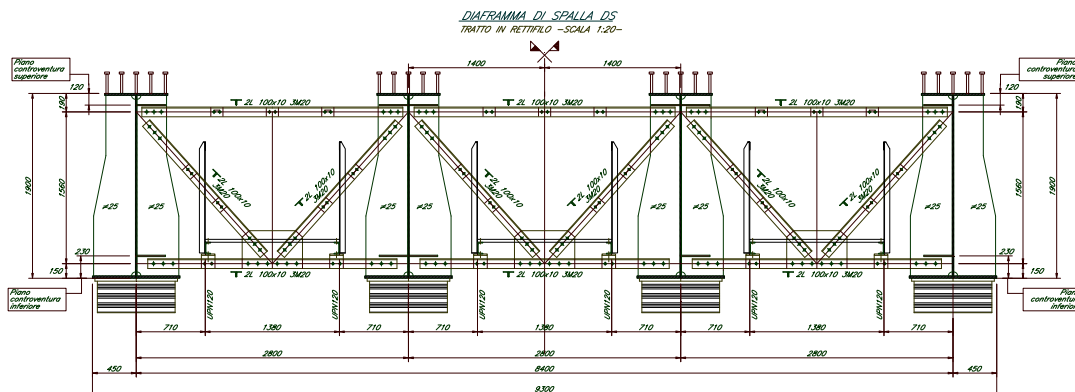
Sezione trasversale su diaframma di spalla
